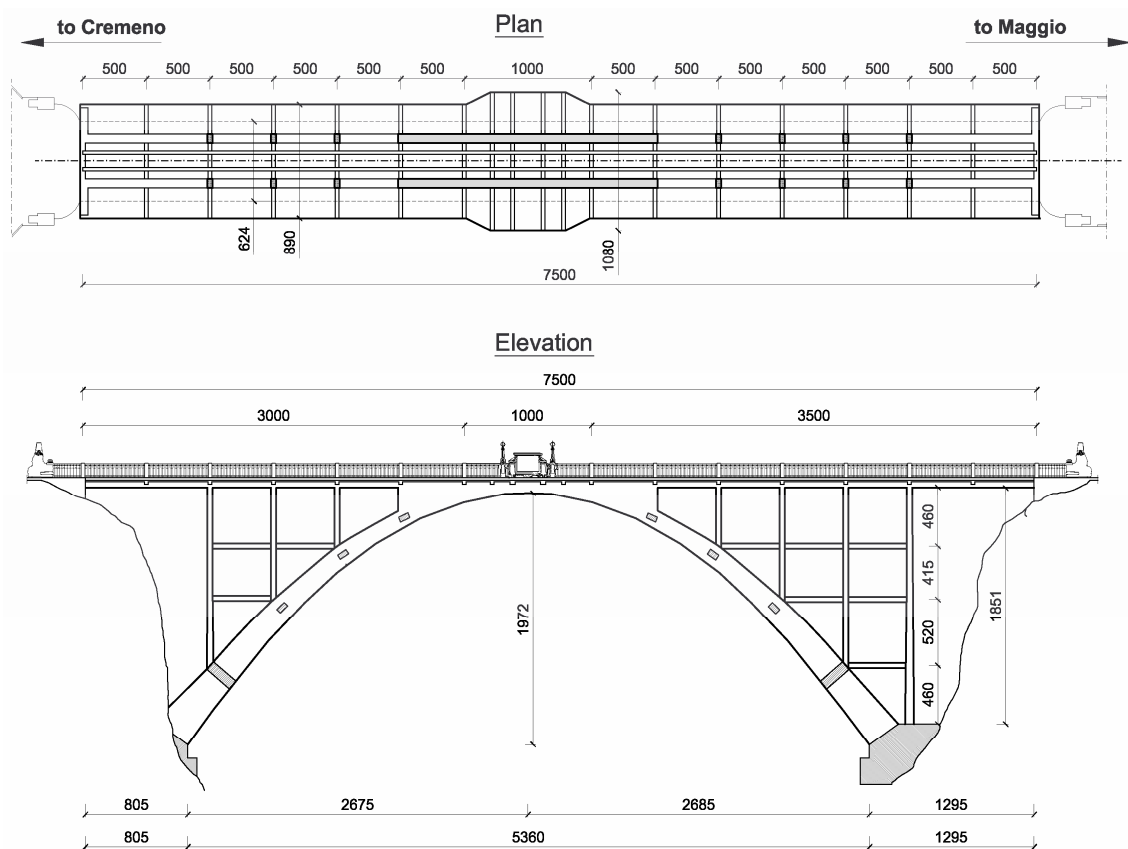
Pianta e sezione longitudinale del ponte della Vittoria nella configurazione attuale
